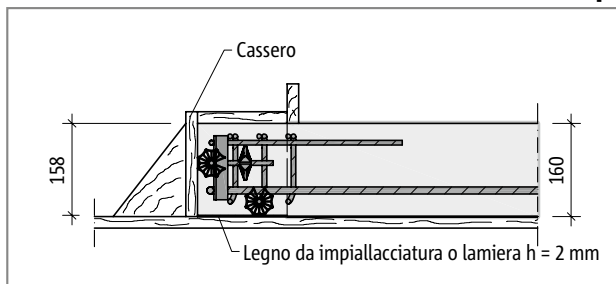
Schöck Tronsole® tipo Z, esecuzione di una mensola d'appoggio sul pianerottolo prefabbricato; spessore del pianerottolo  $h = 160$  mm
